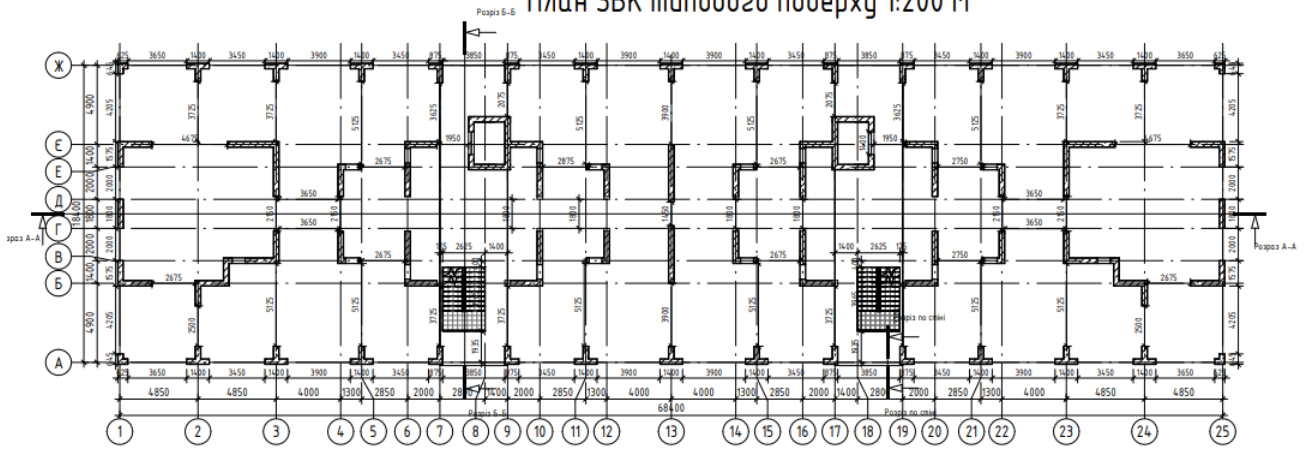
План розташування монолітних несучих стін у будинку Б-1.
